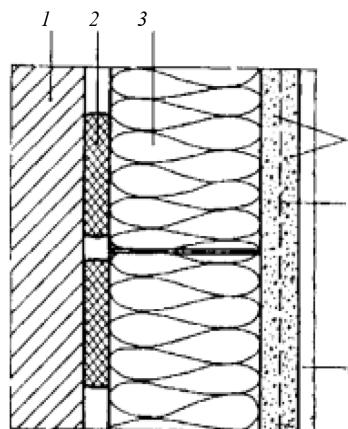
Конструкция стены с наружной теплоизоляцией с оштукатуриванием плитного утеплителя: 1 – кирпичная или каменная стена; 2 – клей; 3 – плитный утеплитель; 4 – армирующая сетка; 5 – штукатурное покрытие; 6 – наружный декоративный слой покрытия
